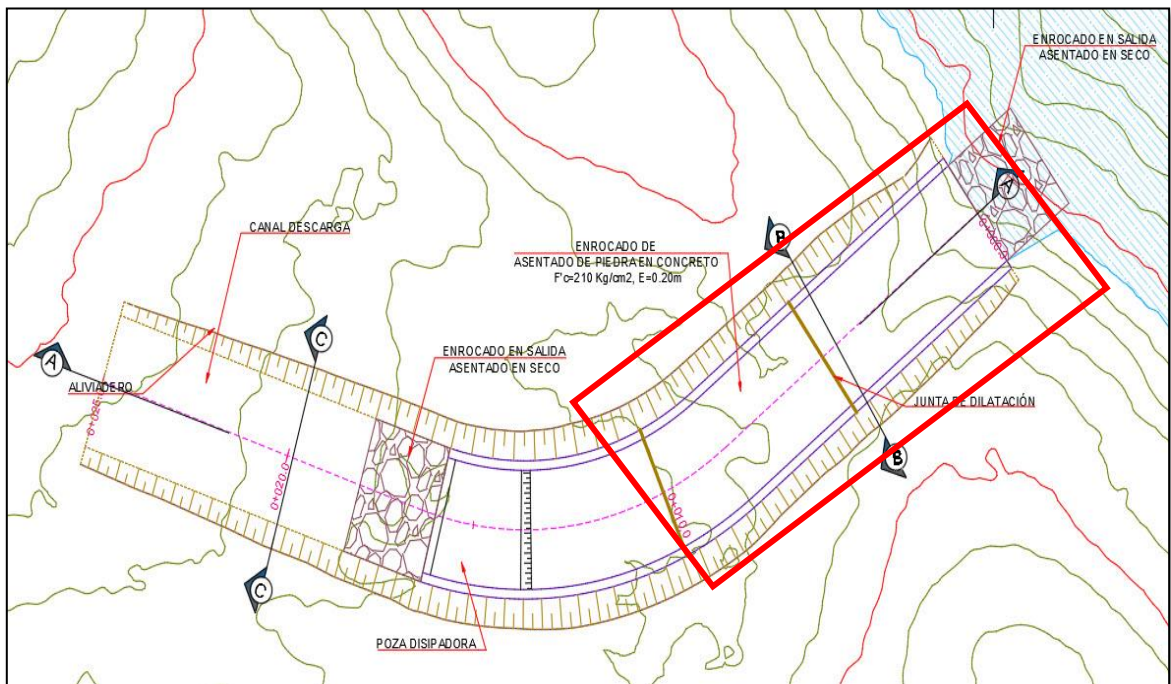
Detalle de Aliviadero en Qocha QOLPANAQOCHA
